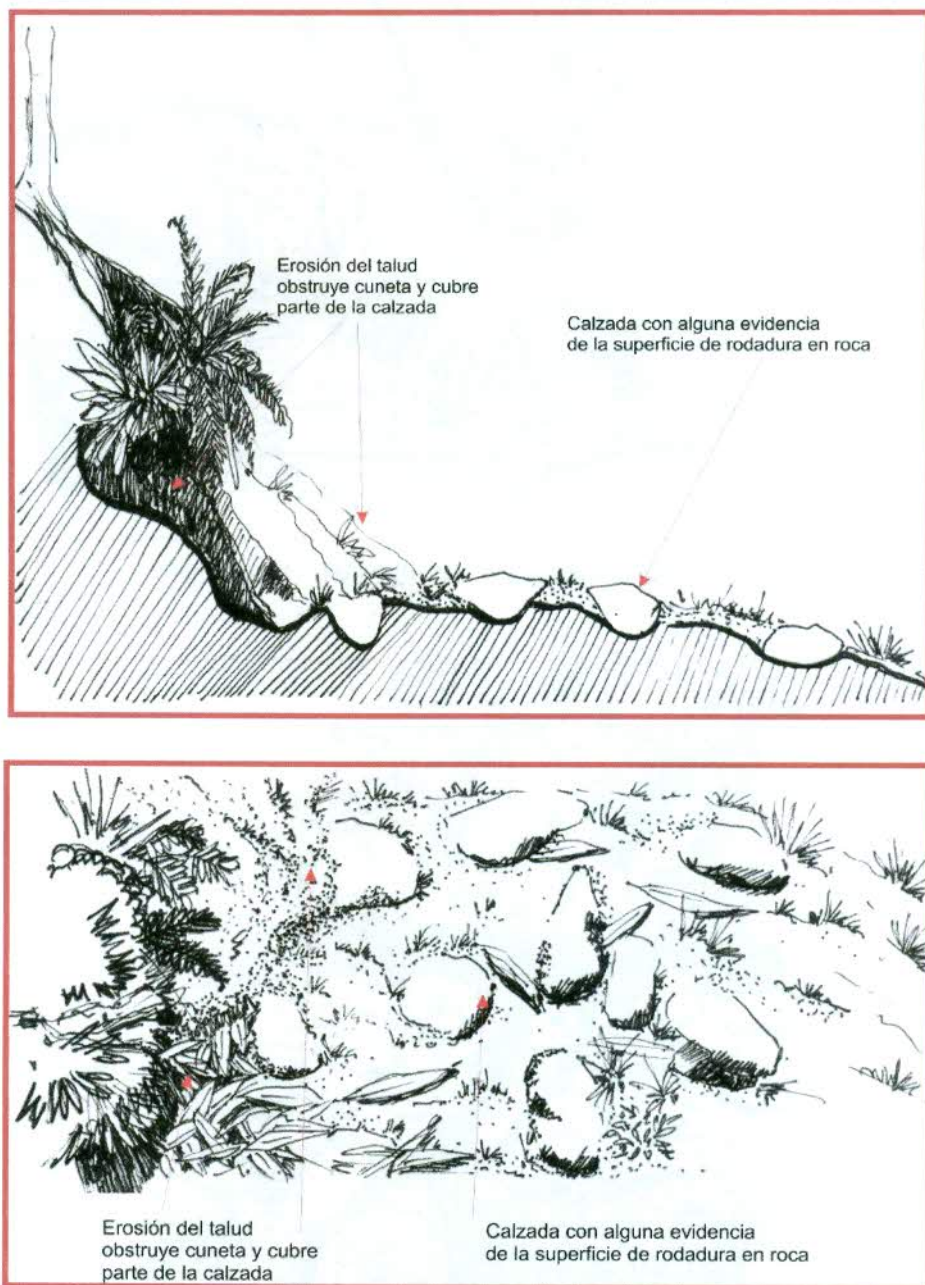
Planta y sección calzada con evidencia parcial de la carpeta
